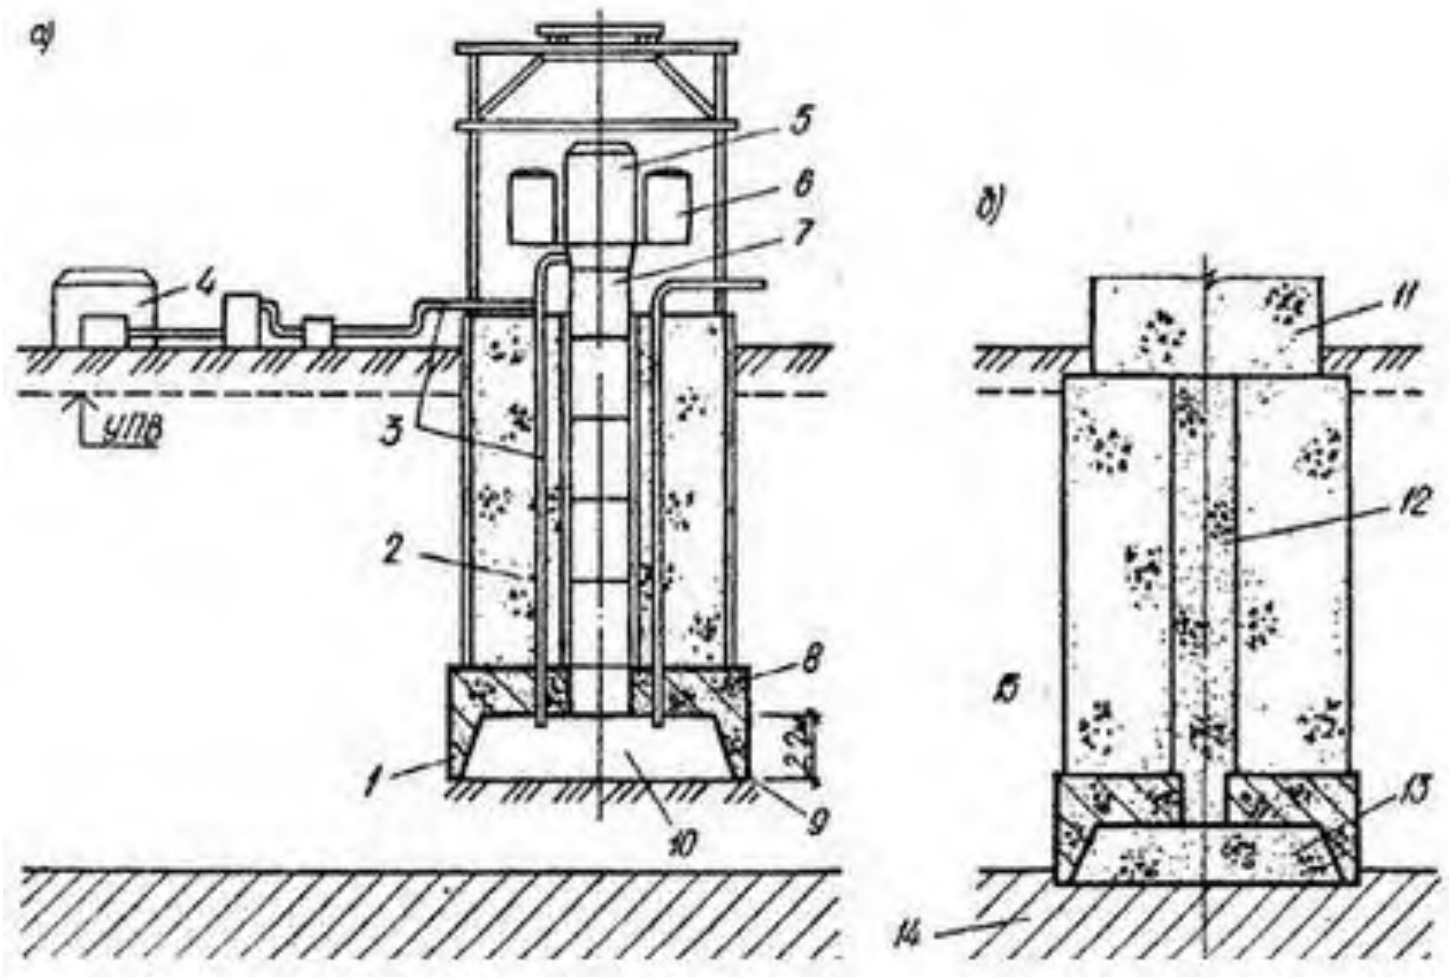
Кессон: а — погружение кессона; б — кессонный фундамент; 1 — консоль; 2 — надкессонная кладка; 3 — трубы для сжатого воздуха; 4 — компрессорная станция; 5 — центральная шлюзовая камера; 6 — прикамерки; 7 — шахтные трубы; 8 — потолок кессона; 9 — нож; 10 — рабочая камера кессона; 11 — кладка надфундаментной части опоры; 12 — бетон заполнения шахты; 13 — бетон заполнения рабочей камеры; 14 — прочный грунт; 15 — слабый грунт
